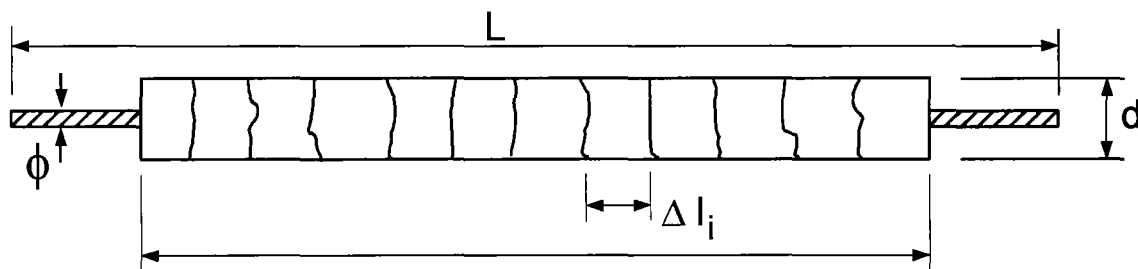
Após ensaiado, o corpo de prova (Figura 5) apresenta fissuras.
